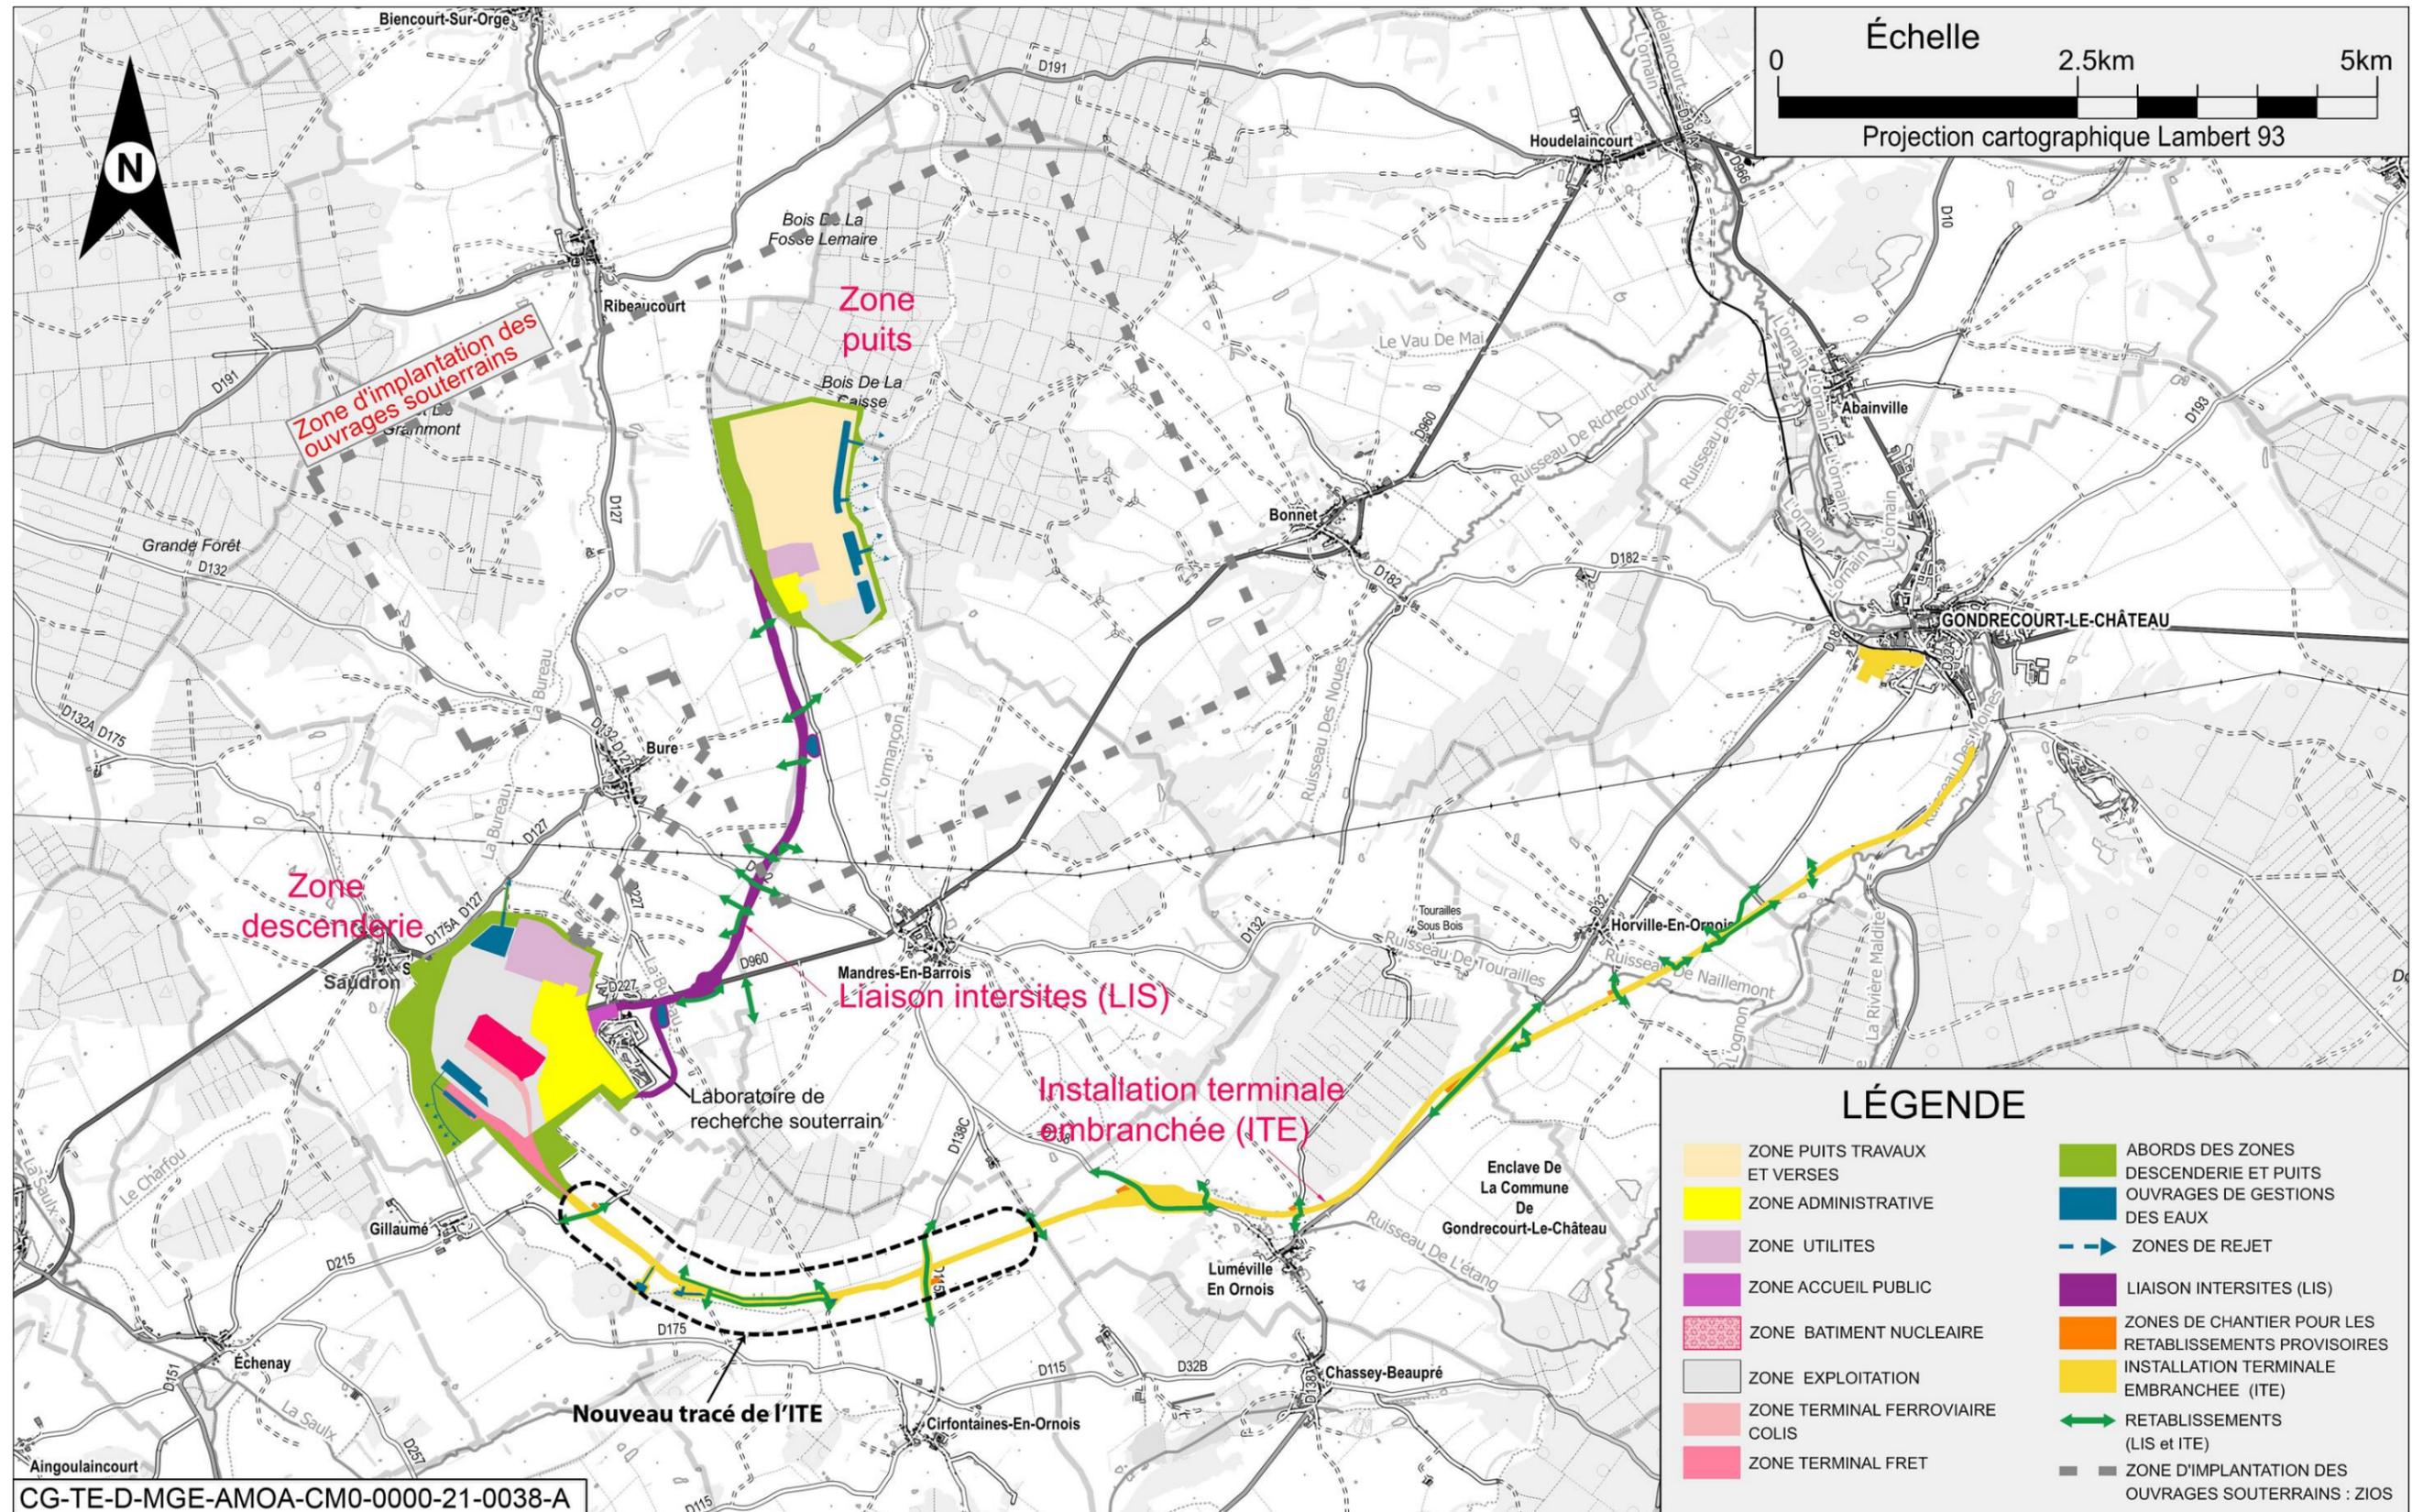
Plan général des travaux du centre de stockage Cigéo
